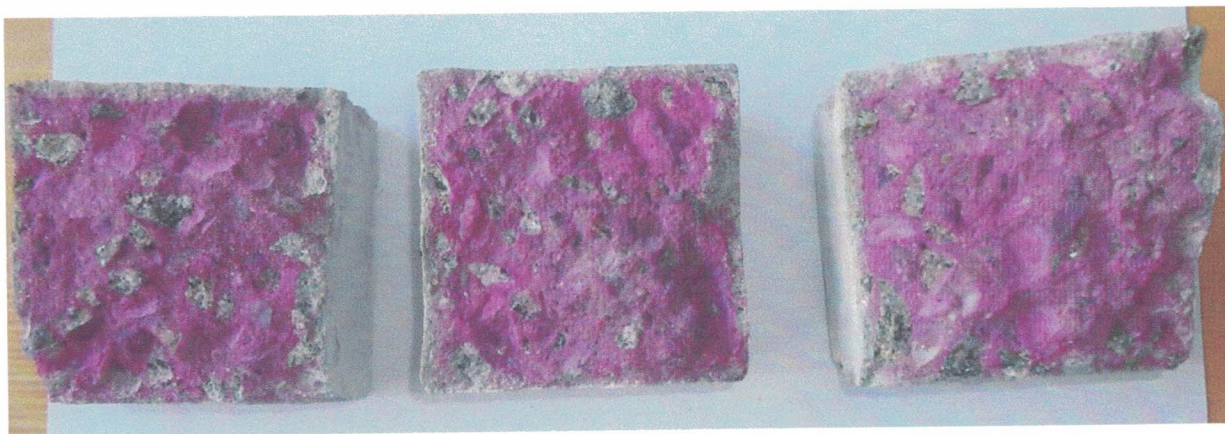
Внешний вид бетонных образцов с нанесенным материалом «Пенетрон» после 14 суток испытаний.
